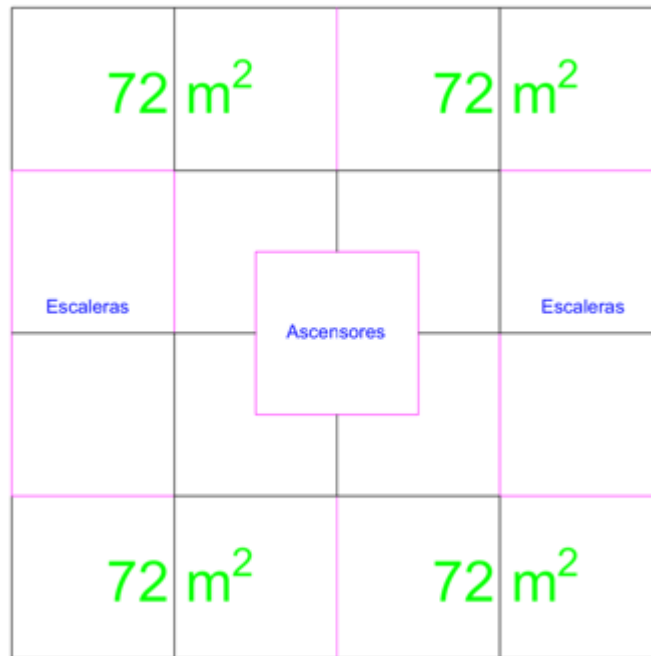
Esquema de planta típica, edificación de gran altura; muros en magenta.
